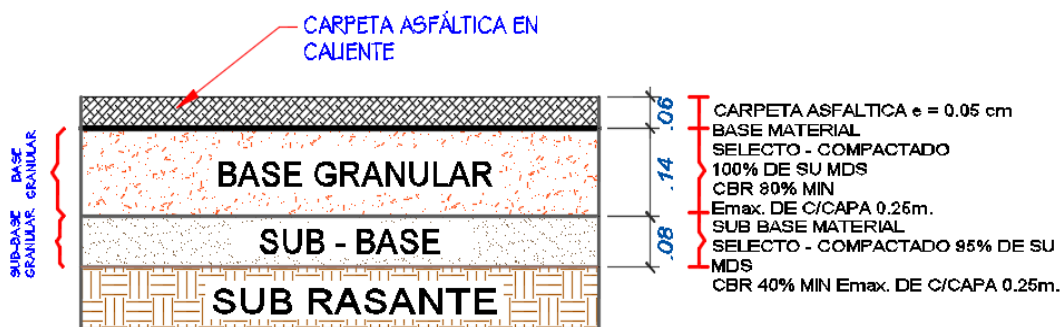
Comparación de pavimentos con geotextil en su función de filtración.
